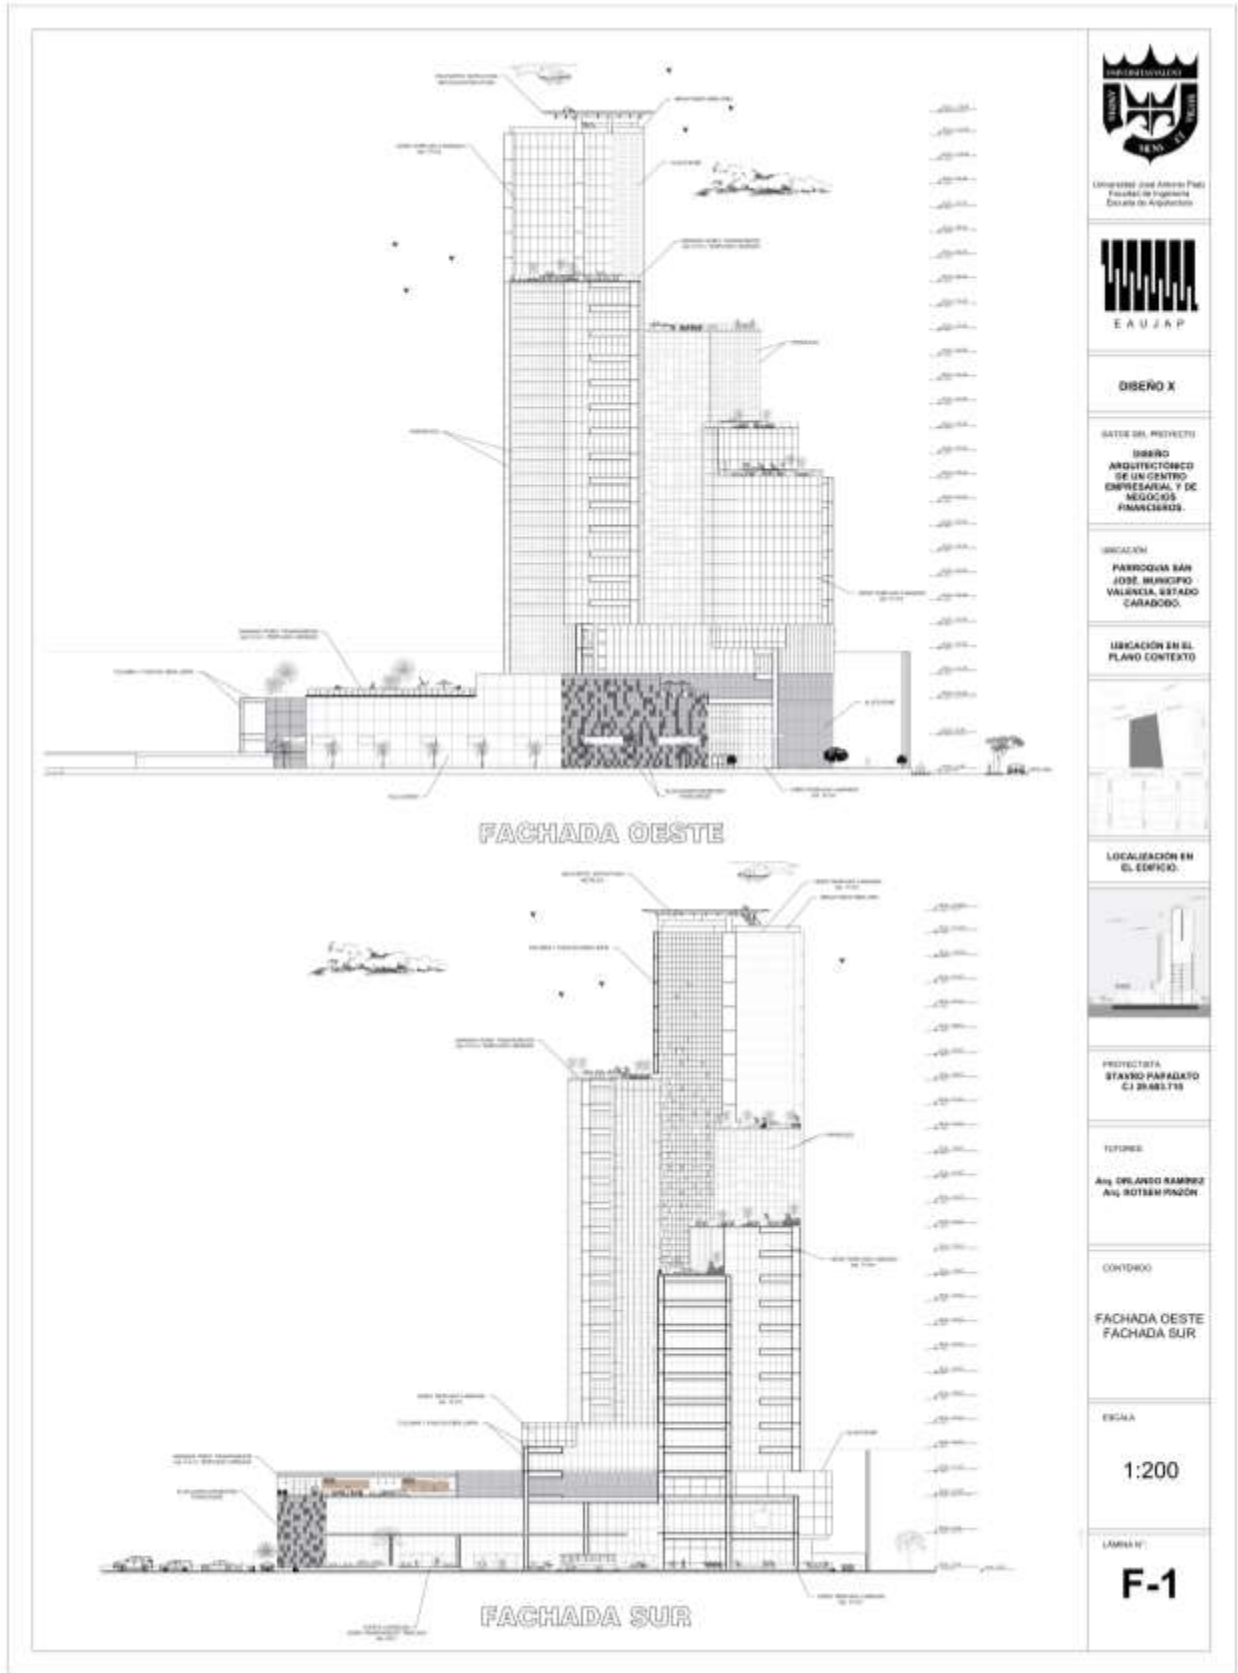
F-1 Fachada Oeste / Fachada Sur Fuente: El Autor (2023)
